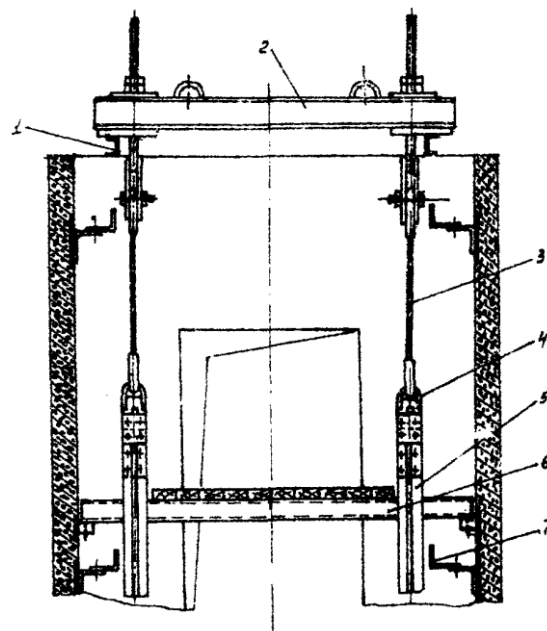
Установка траверсы с "нитками" направляющих на балки:
